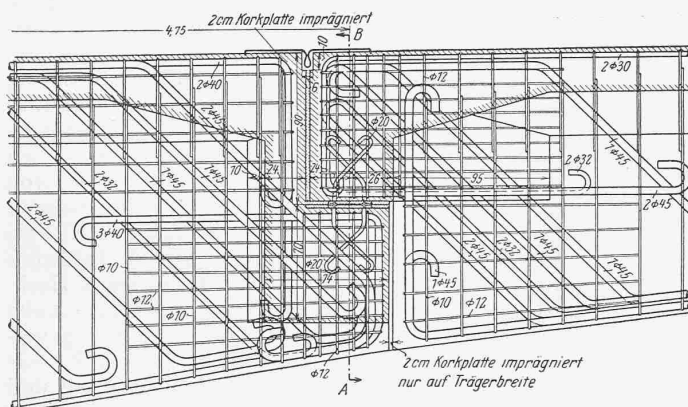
Bewegliches Gerbergelenk; Masstab 1:40. Detail des Platten-Gleitlagers siehe Abb. 5.
